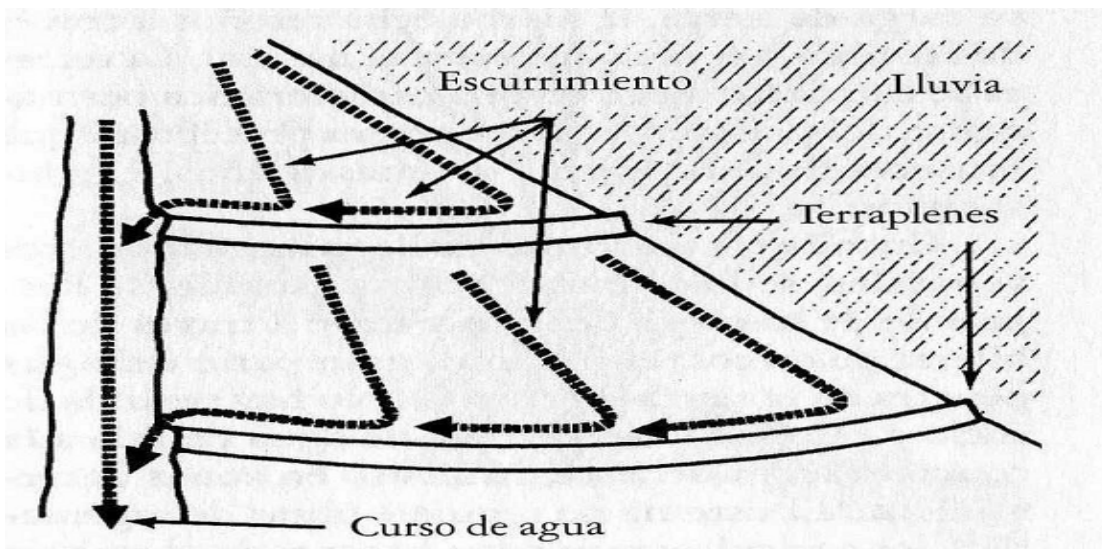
Drenaje con arreglo de acuerdo al sistema construido de terraplenes
